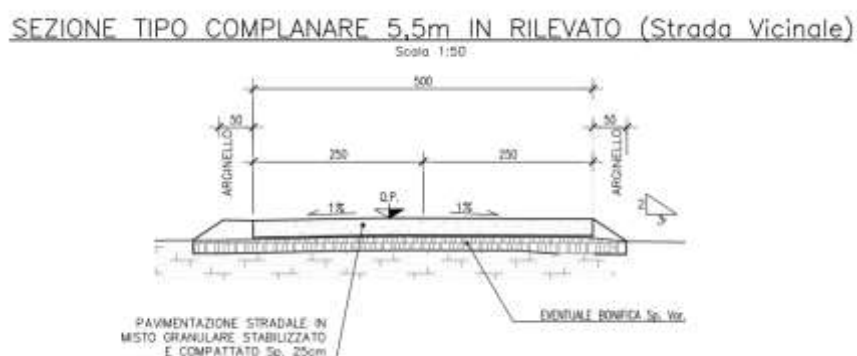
Sezione tipo complanare 5,5 m in misto stabilizzato
